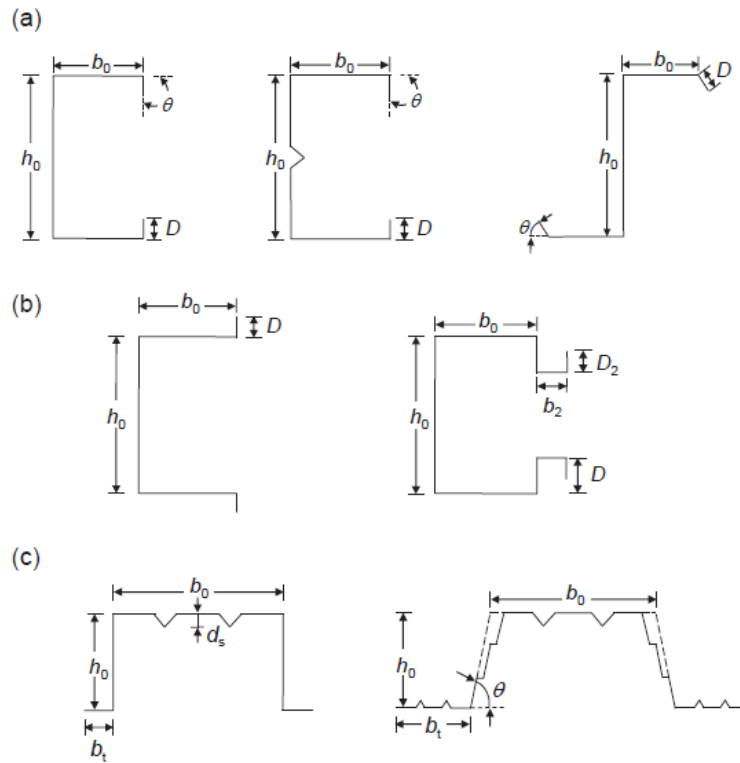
Formes de section transversale préqualifié : (a) colonnes et poutres ; (b) des colonnes ; et c) des poutres
